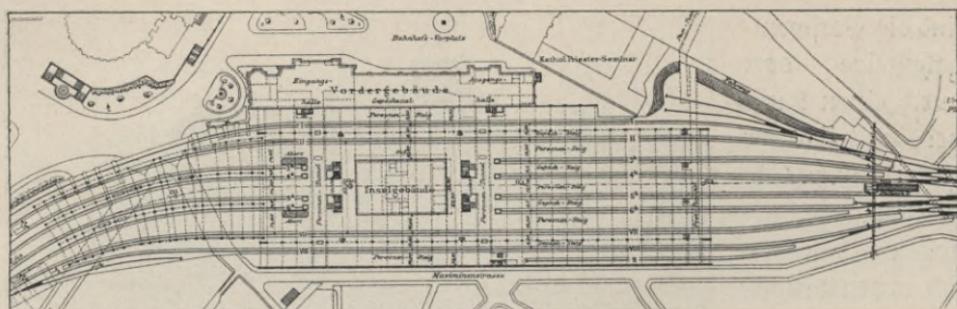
Grundriß des Kölner Hauptbahnhofs.
